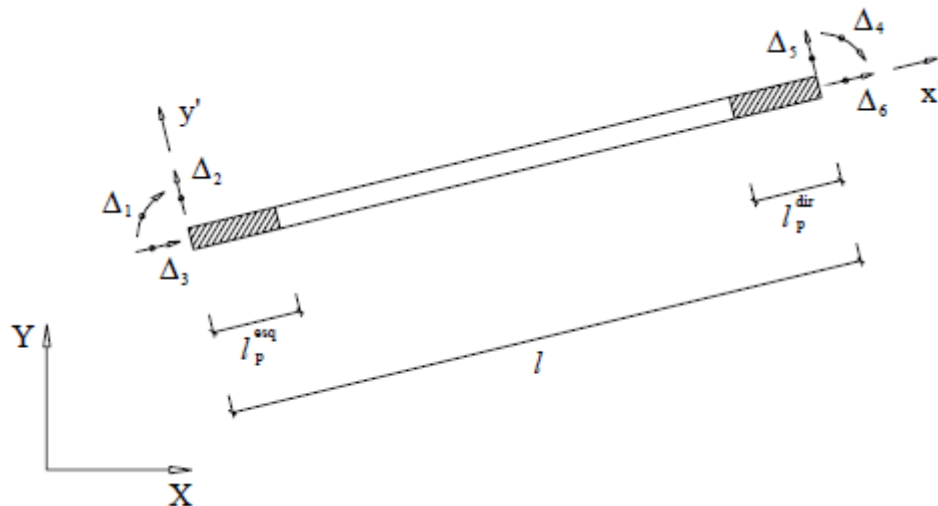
Localização do comprimento da rótula plástica no elemento de barra (Delgado, 2009).
